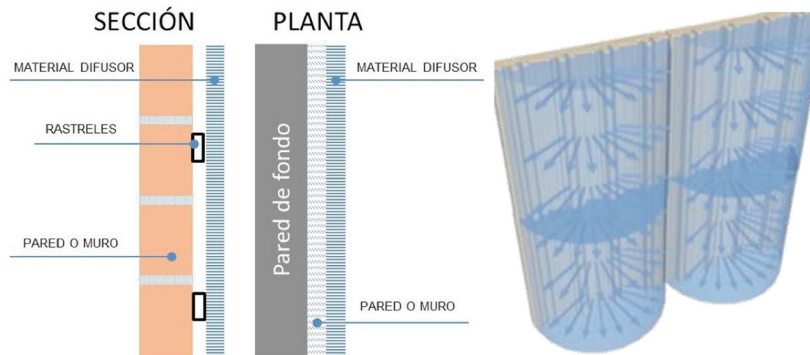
Detalle constructivo pared. Vanessa Cruz 2014.
